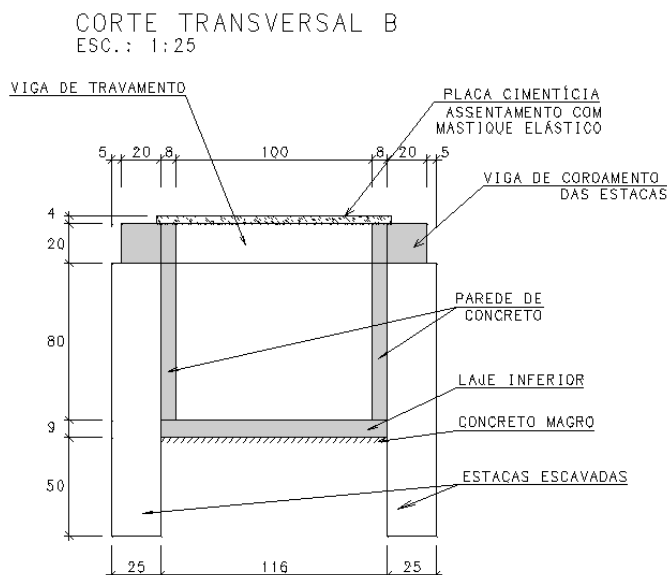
Corte Transversal nas Lajes Pré-moldadas
